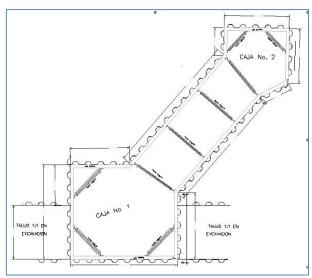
Planta de Tablaestacado y puntales, para el proceso de construcción de las cajas C-1 y C-2.
